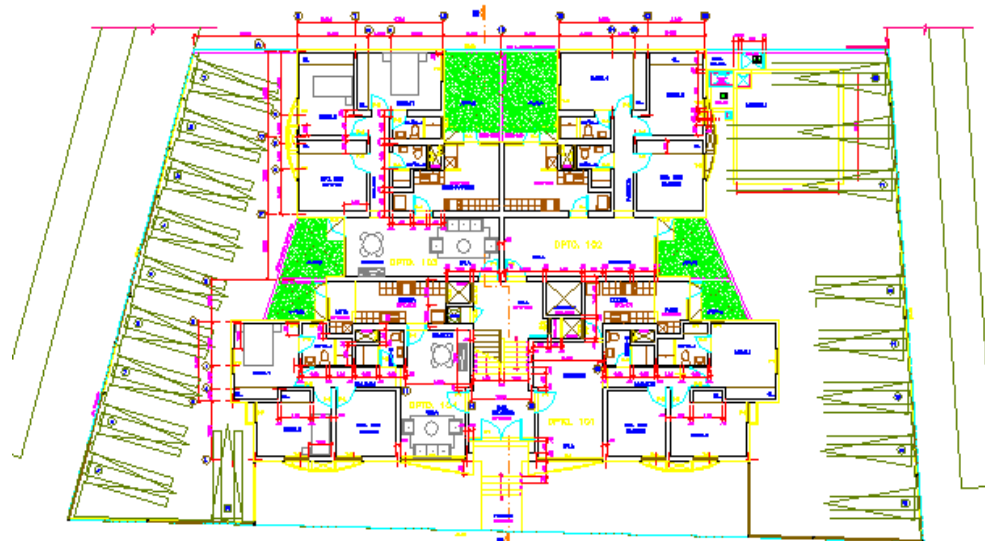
Vista en planta del primer nivel, 1er y 2do bloque.
